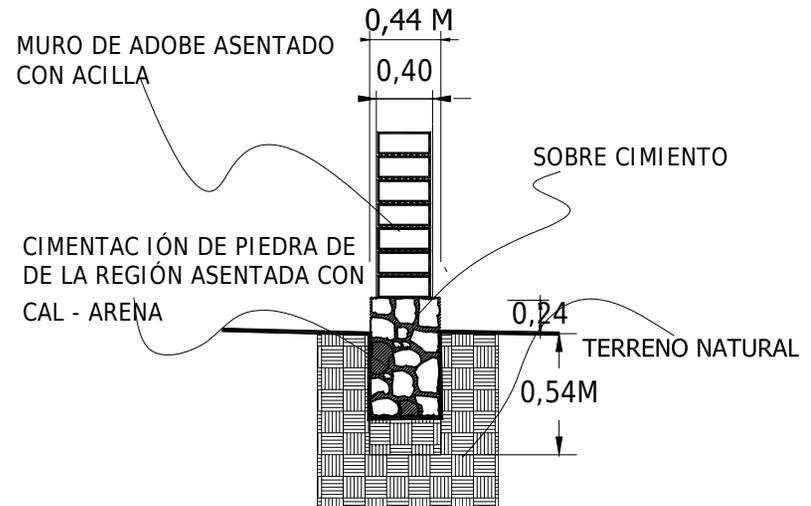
CIMENTACIÓN DE LA VIVIENDA TIPO
